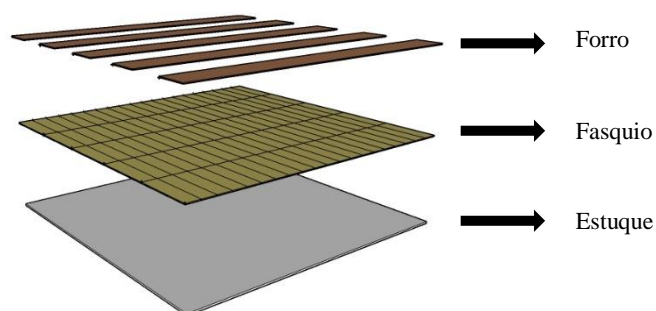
Esquema das camadas do revestimento inferior de pavimentos de madeira
